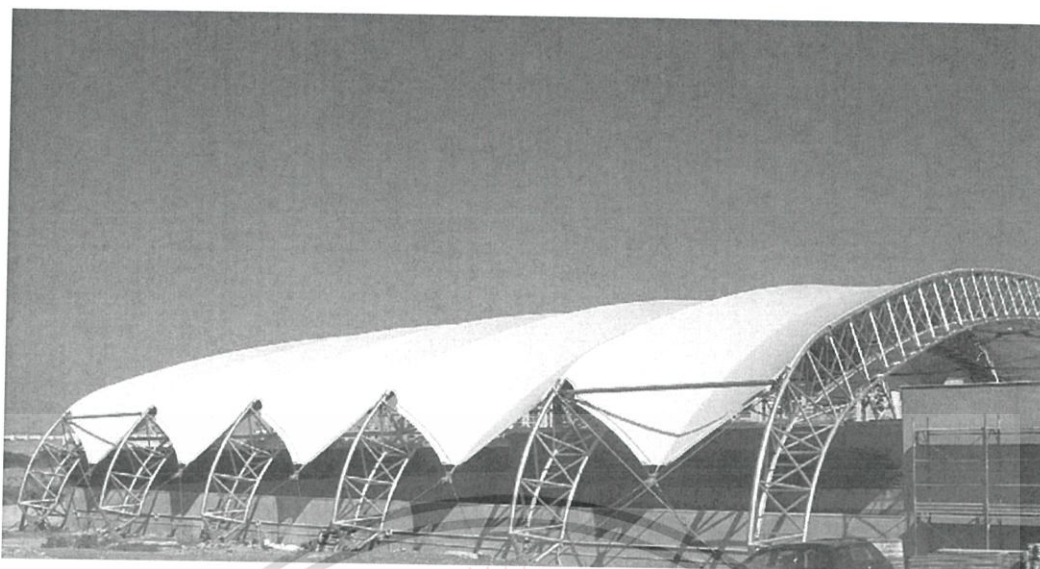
1 ระบบโครงกระดูก (Skeleton Structure)
